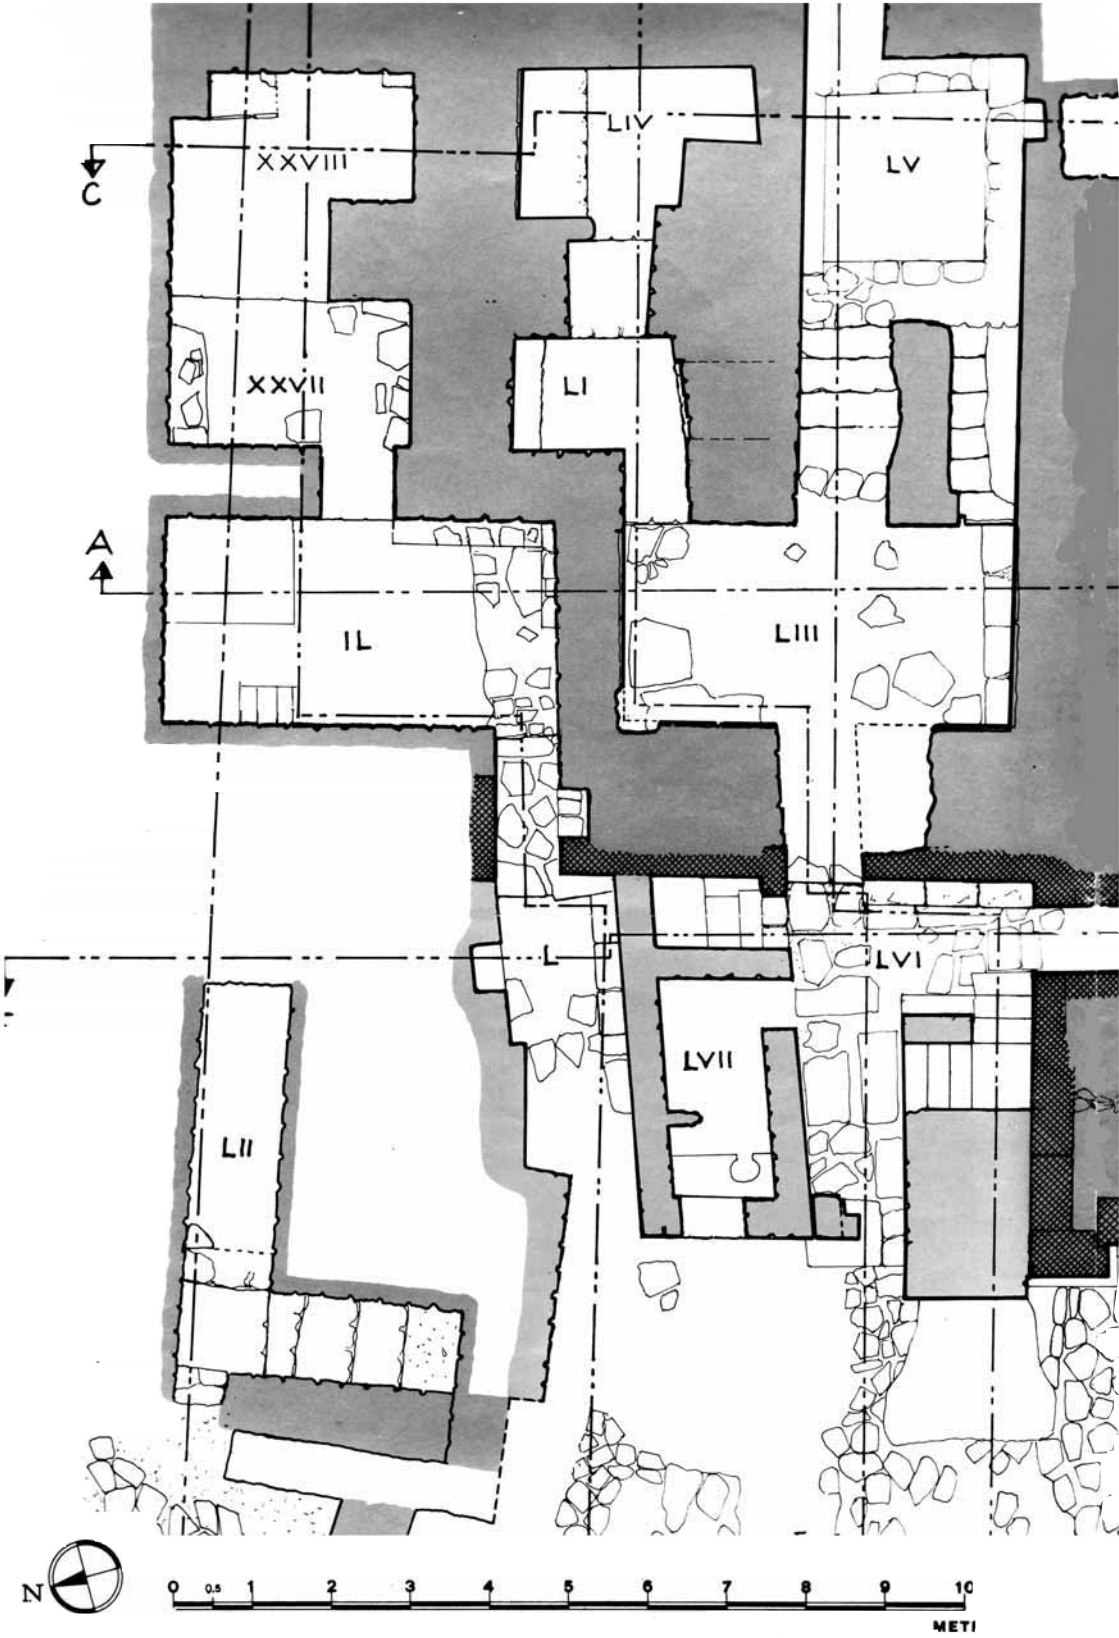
PLANIMETRIA DEI BLOCCHI A E B, AL PIANO TERRENO IN GENERALE CORRISPONDENTE ALLA I FASE LEVI (DA LEVI 1976, TAV. C).
